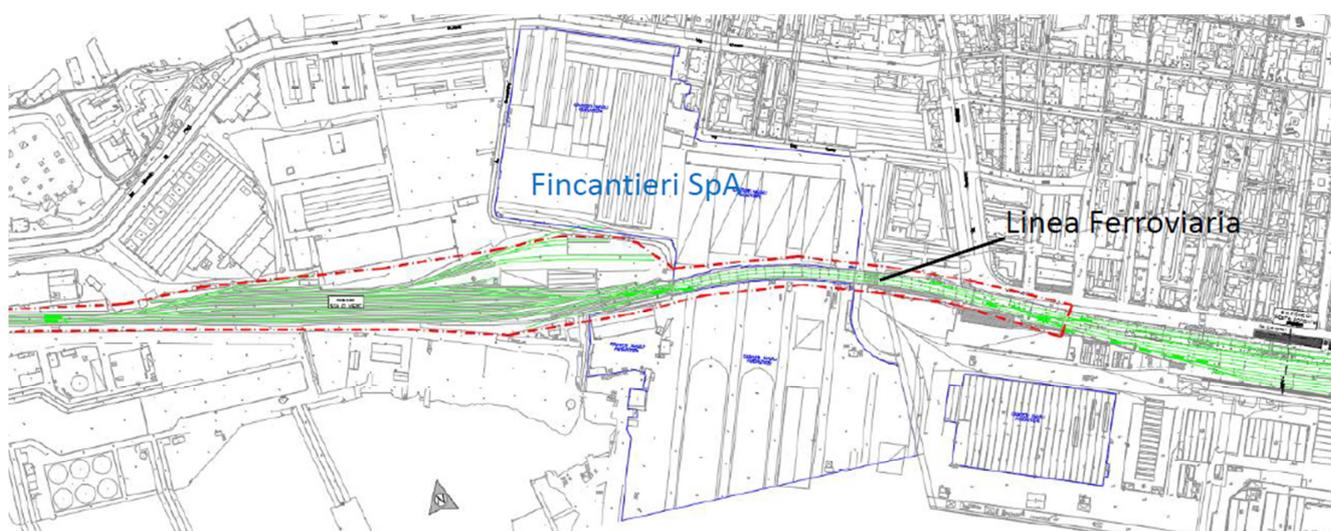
tracciato linea ferroviaria - stato di fatto
